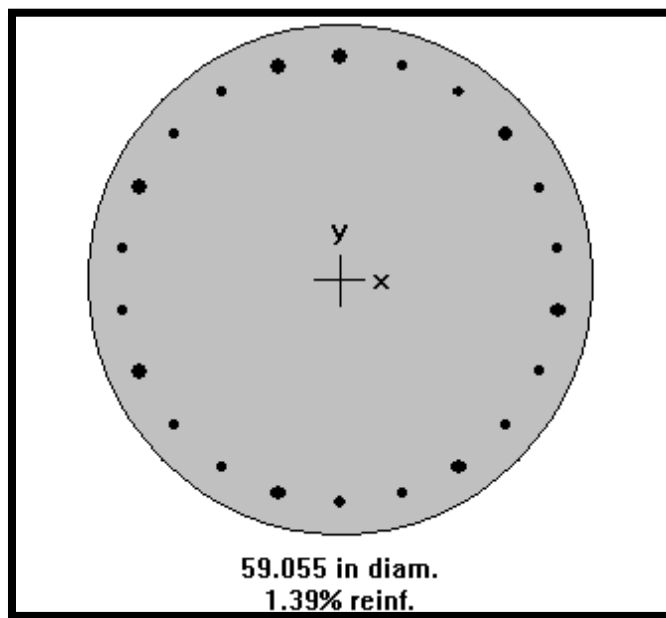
Sección de columna para diseño pila No.2
